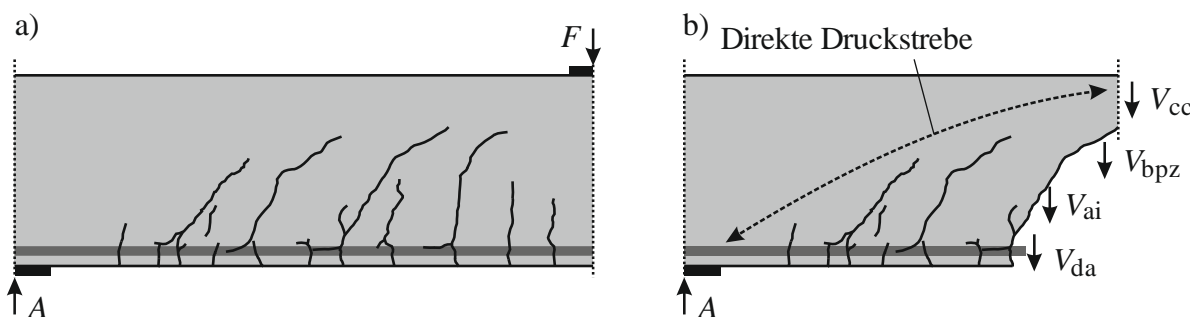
a) Balken belastet durch eine Einzellast mit Rissbild; b) Tragmechanismen der Querkraft in einem betrachteten Schnitt des Balkens
